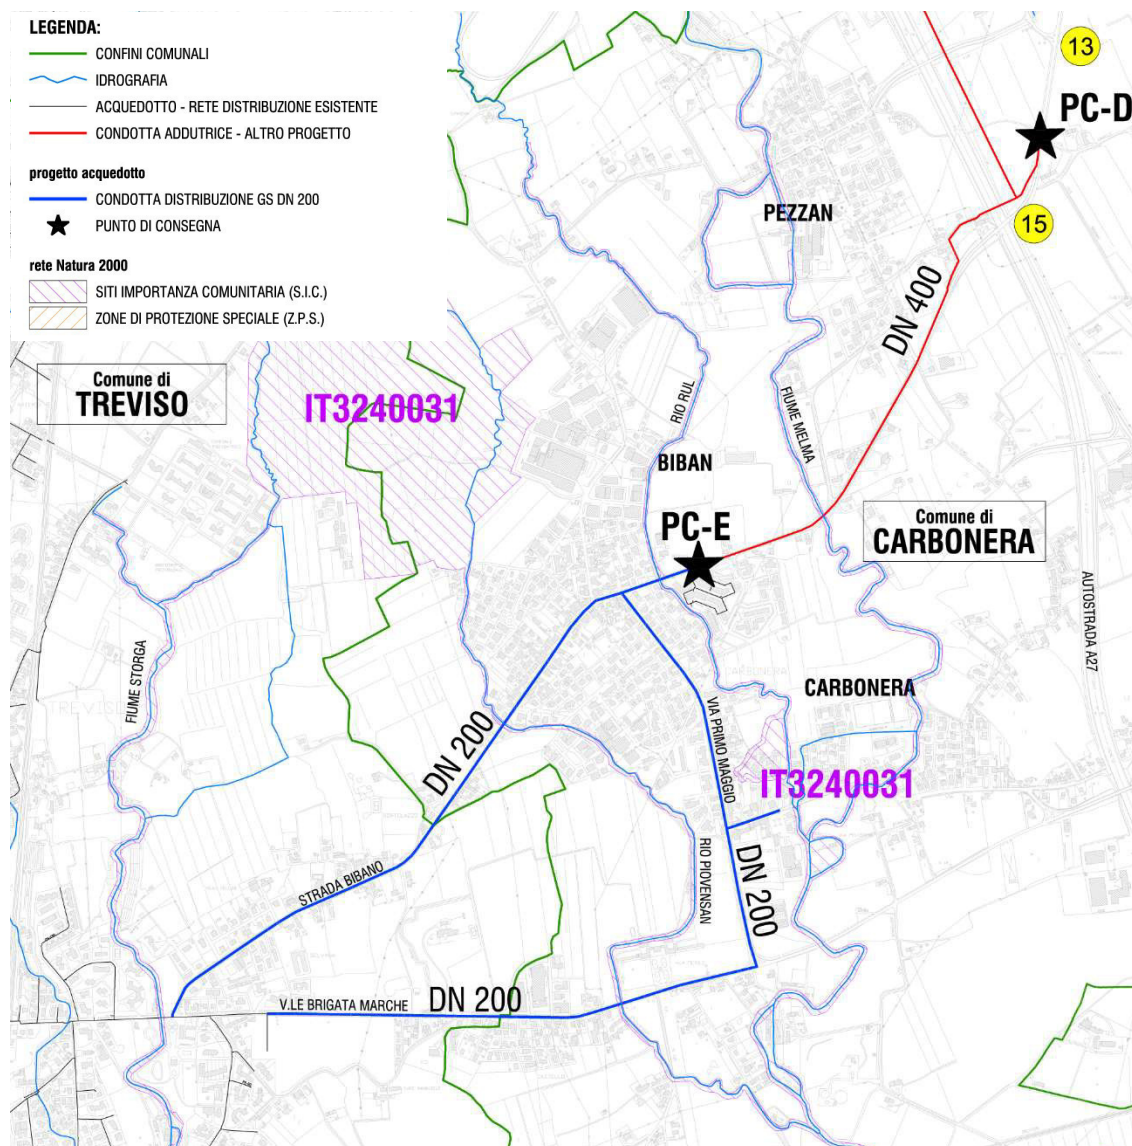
Planimetria delle opere di progetto e delle aree SIC-ZPS: la nuova rete di distribuzione attraversa le aree SIC dei corsi d'acqua Rio Piovensan e Rio Rul, la futura rete di adduzione verso Salettuol attraversa l'area SIC del Fiume Melma
